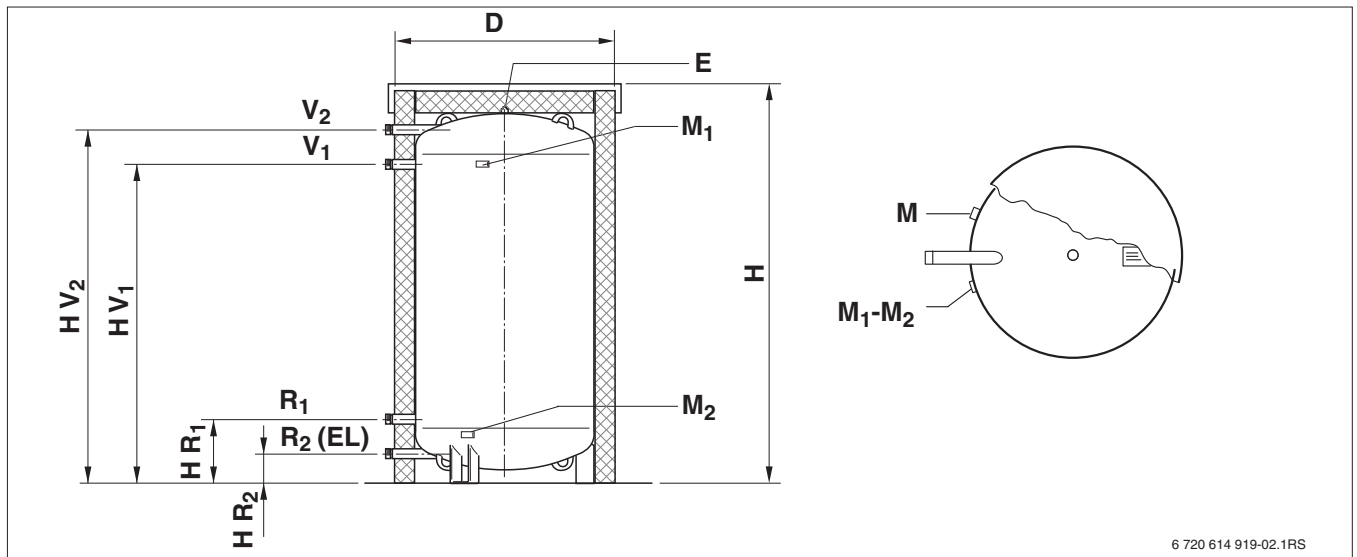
Bau- und Anschlussmaße der Pufferspeicher PSW 300/...-5 (Maße in mm)
